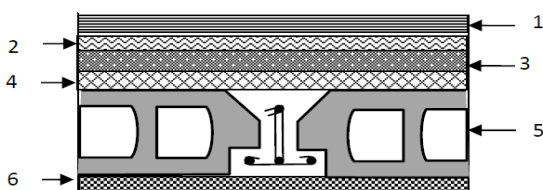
Coupe transversale dans le plancher terrasse inaccessible
